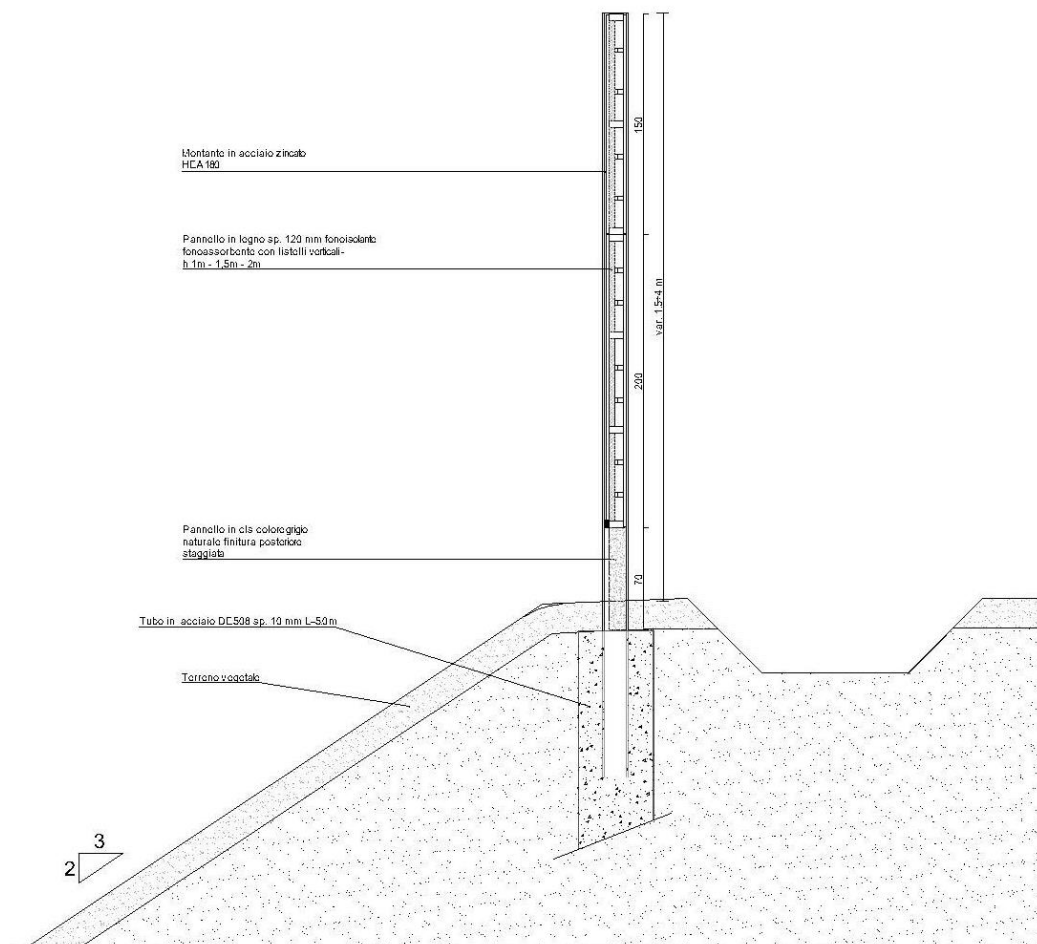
BARRIERA FONDOASSORBENTE CON FONDAZIONE SU PALI
